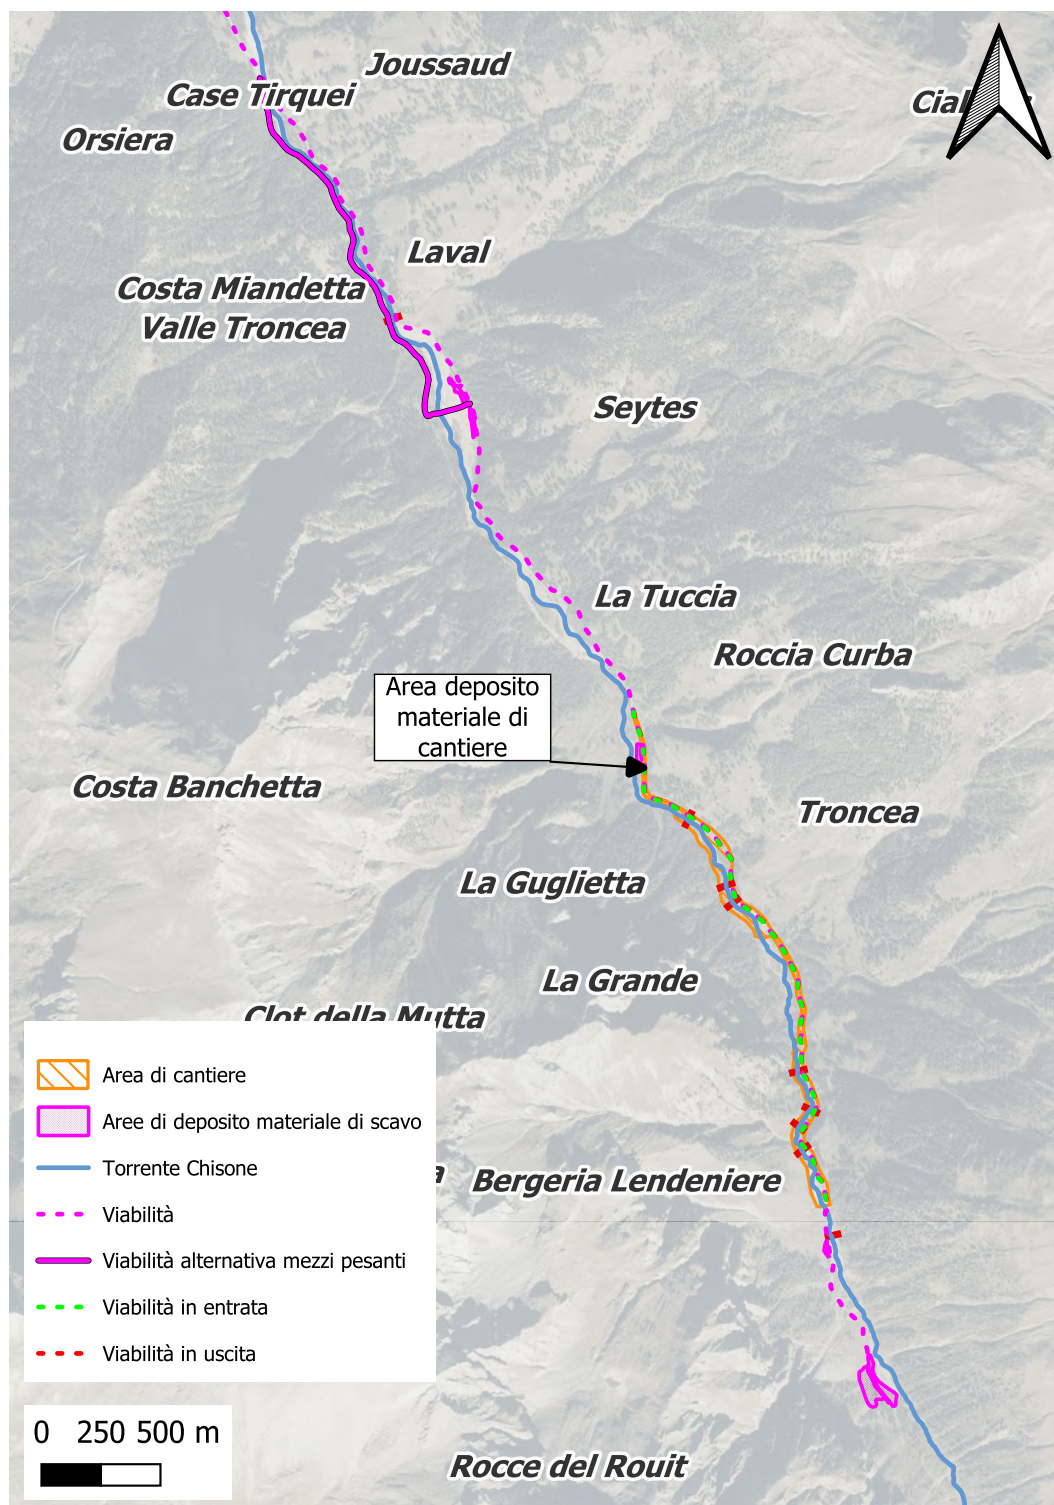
Layout di cantiere e viabilità di accesso al cantiere, lato monte
